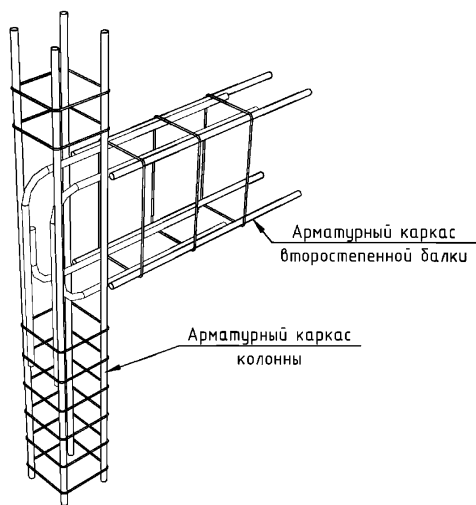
Детальное армирование узла сопряжения второстепенной балки с колонной при анкерке верхней арматуры в колонну
